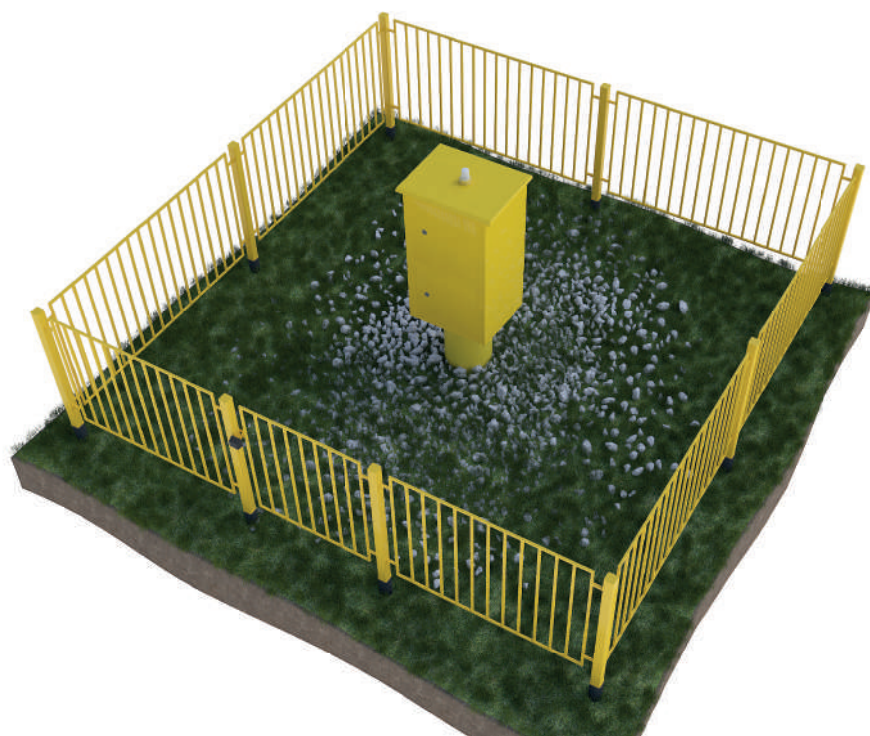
Общий вид площадки кранового узла после монтажа МАК-Э
